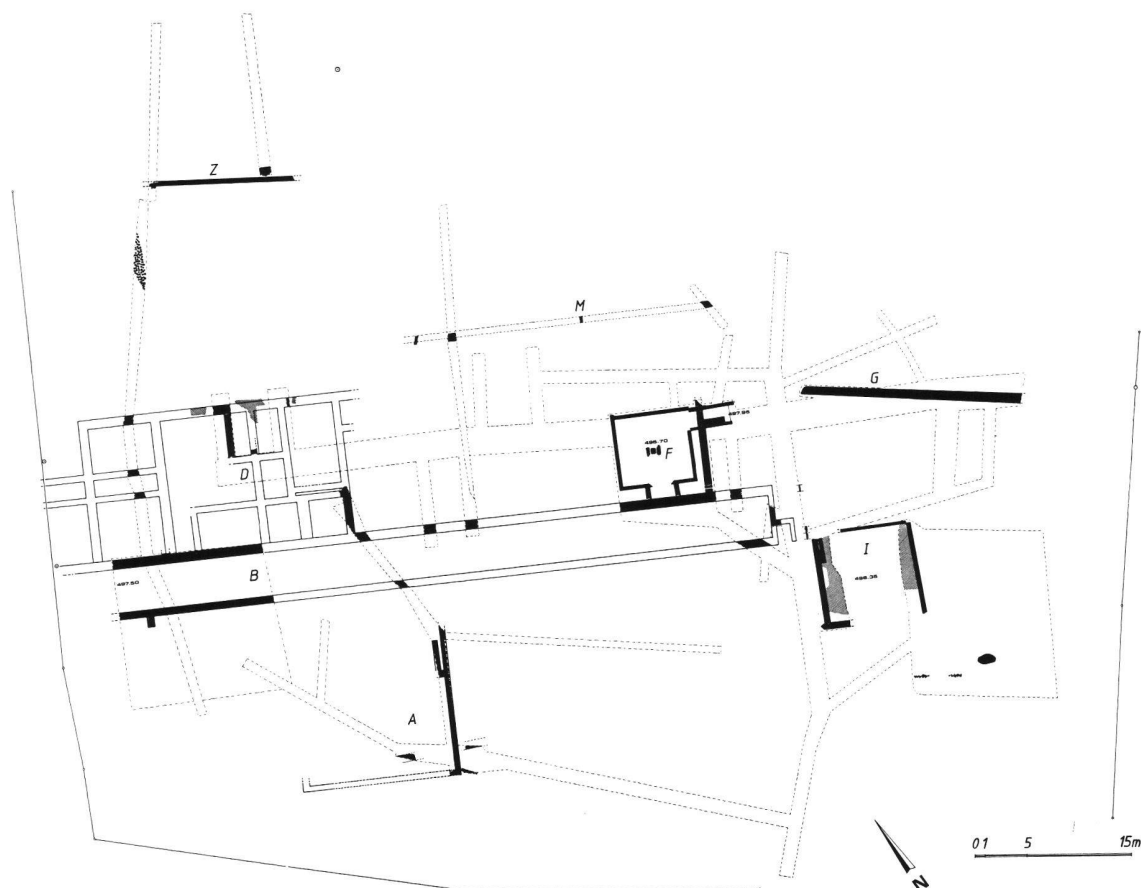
Crissier VD, Montassé. Villa romaine. Plan générale. (Dessin: M. Klausener.)
